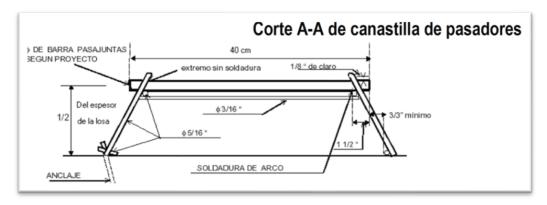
Corte de la canastilla de pasadores Fuente: Elaboración compañía GESCP S.A.S
